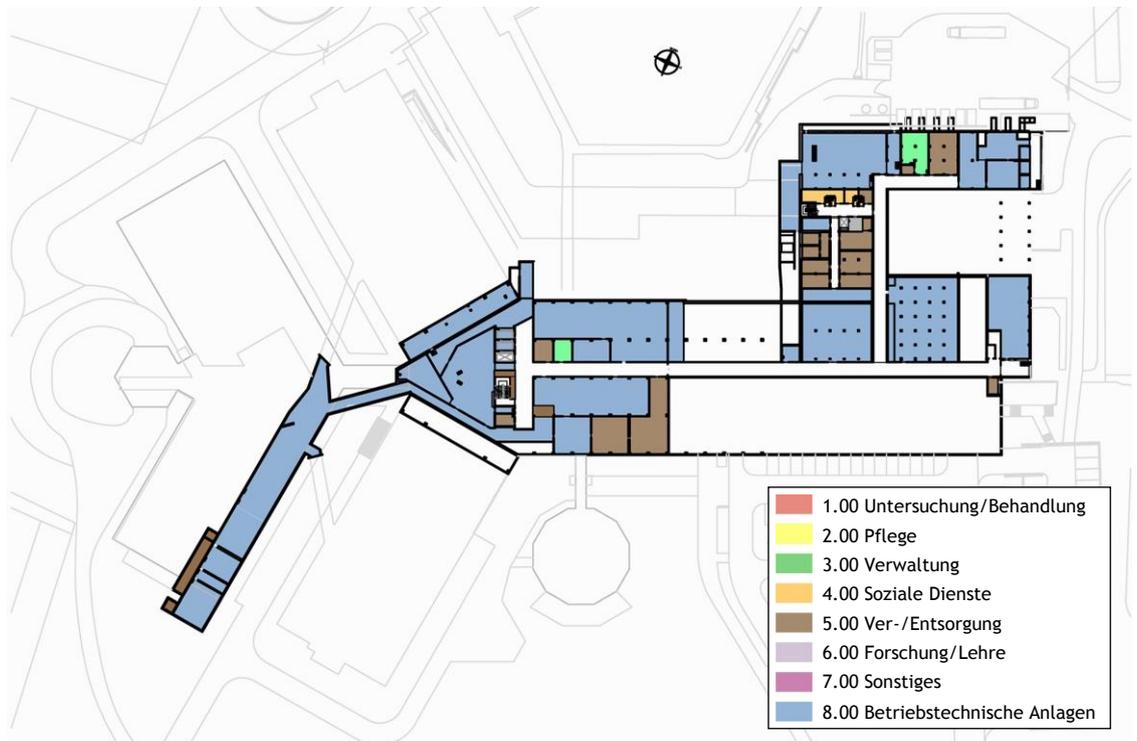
Bestandsflächen nach DIN 13080 - 2.Untergeschoss
